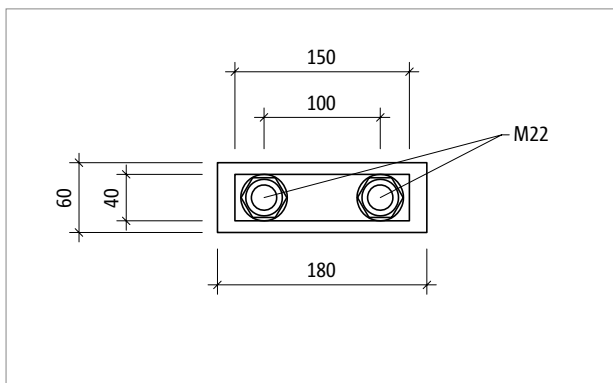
Schöck Isokorb® T typ S-N-D16: Řez prvkem
